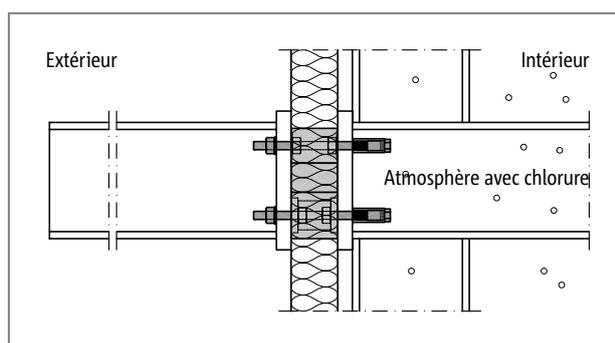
Schöck Isokorb® T type S avec écrous borgnes : construction en acier en porte-à-faux libre; atmosphère intérieure avec chlorure
